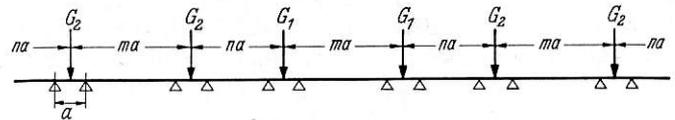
Laststellung zur Bildung einer Achsstandformel mit ungleichen Lasten.
